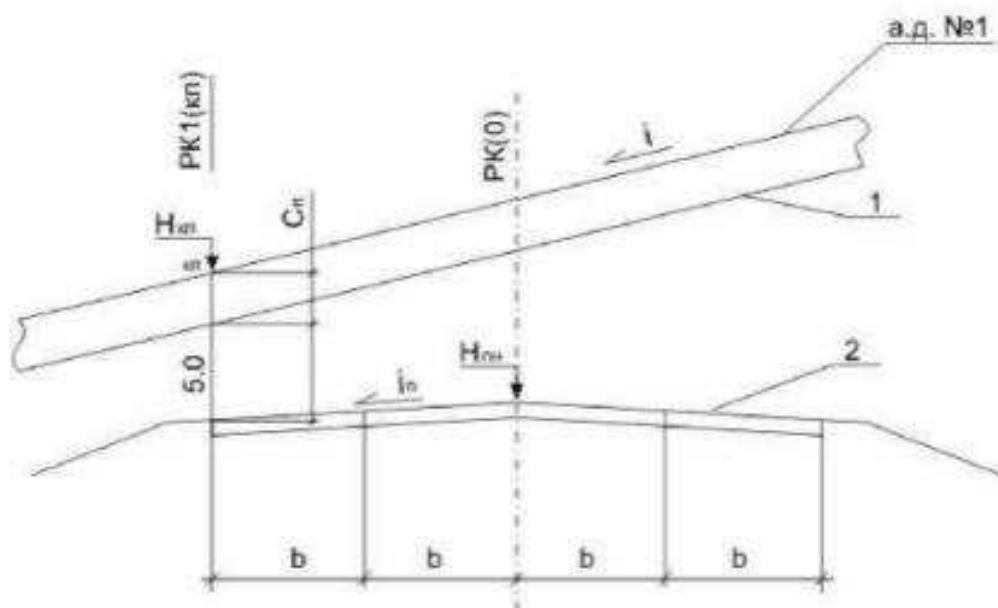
Схема определения контрольной отметки на путепроводе
